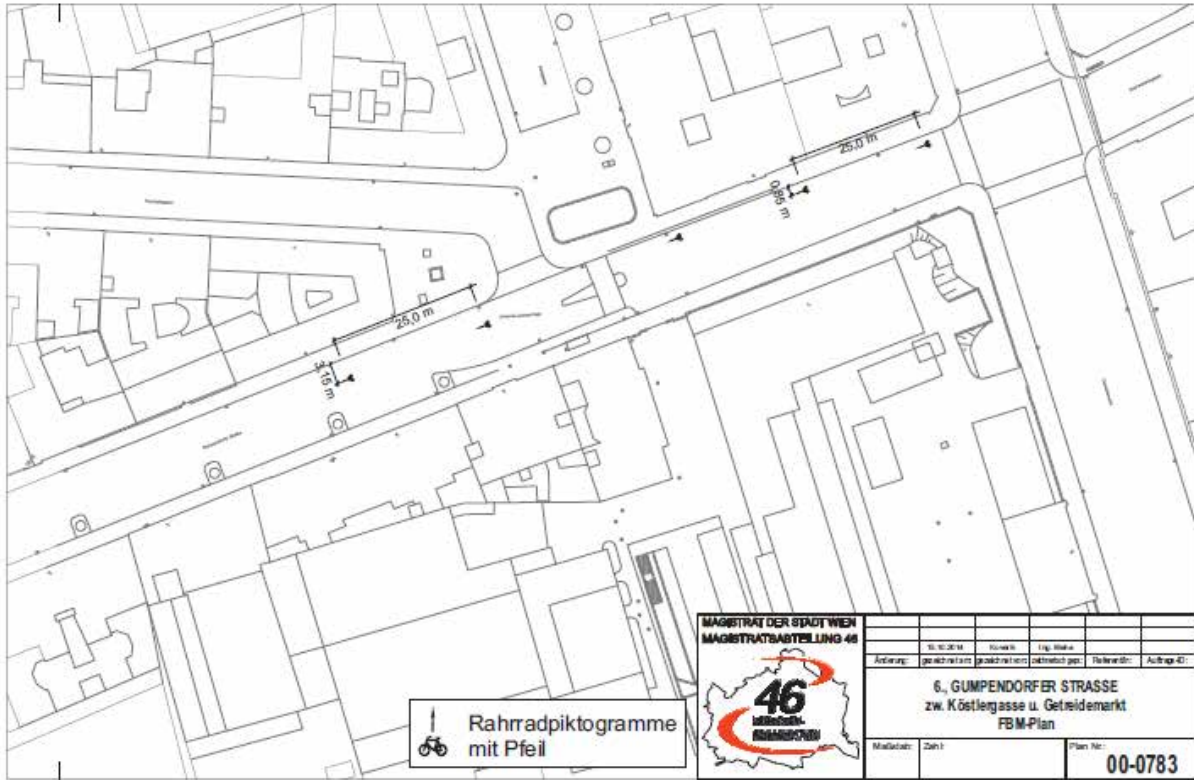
Lageplan des Untersuchungsgebietes Gumpendorfer Straße
